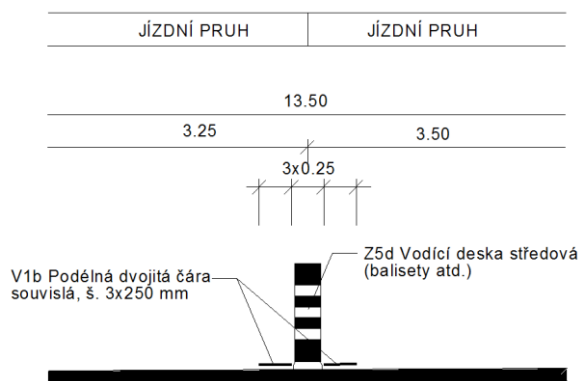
Zmenšení počtu jízdních pruhů před křižovatkou
